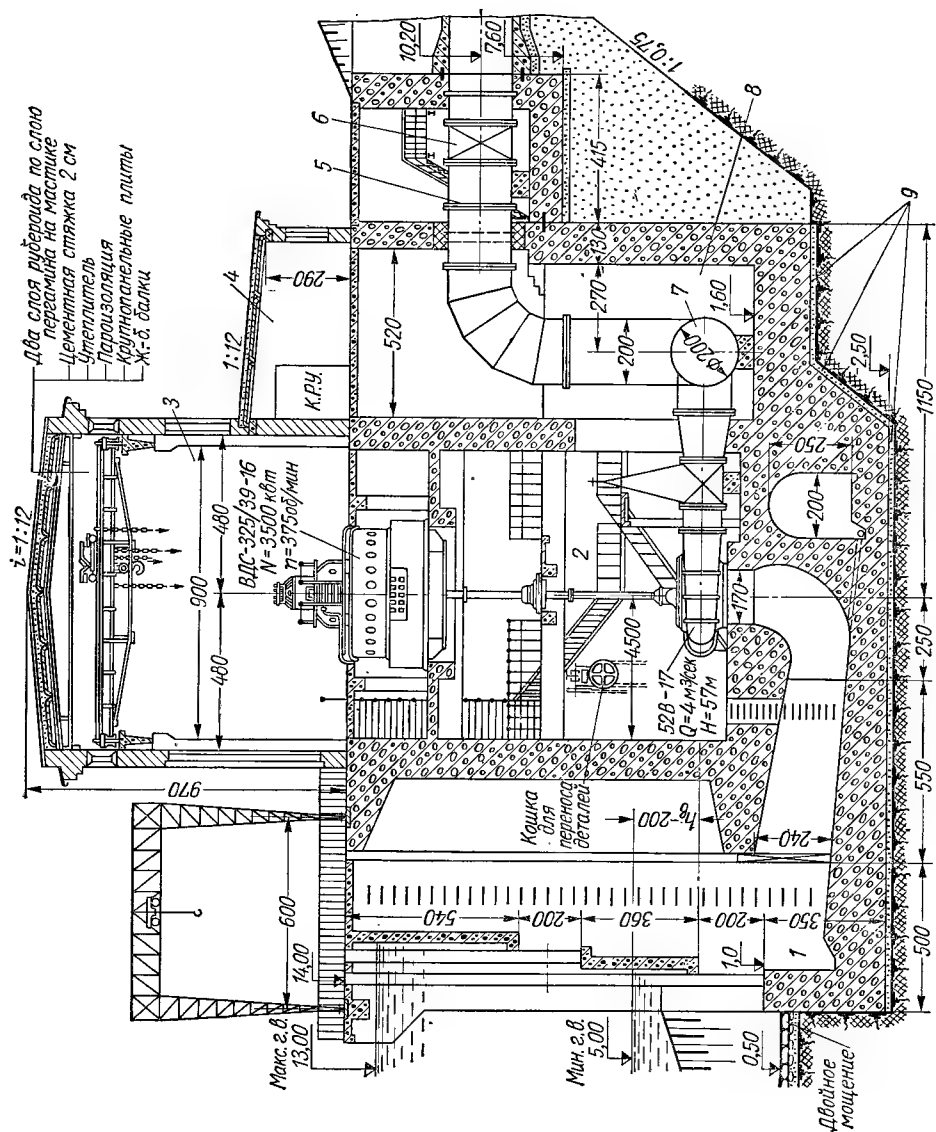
Береговое совмещенное с насосной станцией водозаборное устройство:
